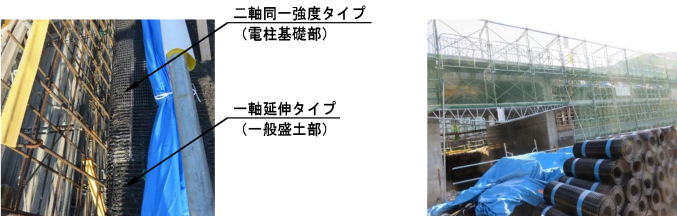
二軸同一強度と一軸延伸タイプのジオテキスタイルを用いた場合の施工状況
